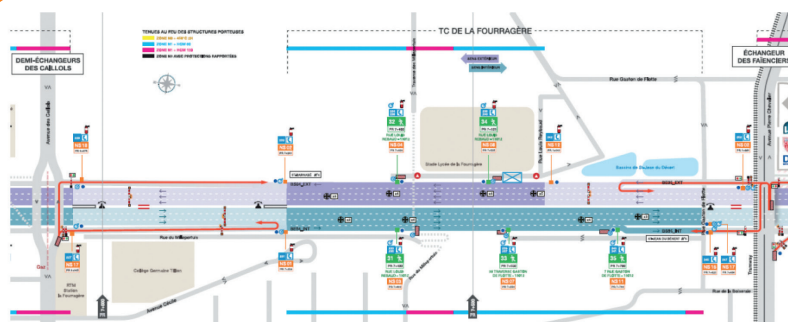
Exemple de plaquette mise en place par la DIRMED pour les tunnels de la L2
